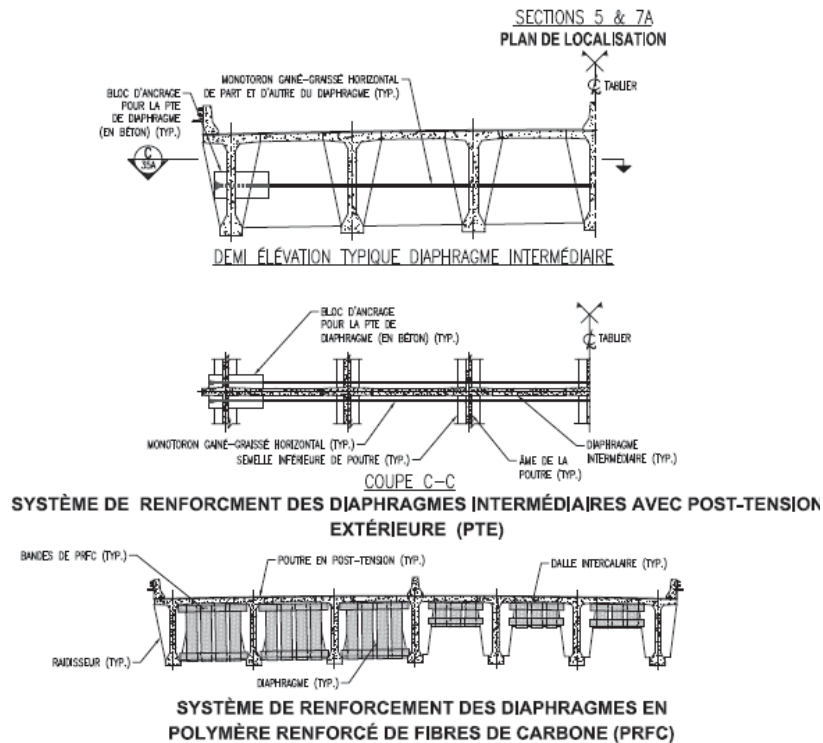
Poutres en béton – Renforcement des diaphragmes (source : plans nomenclature PJCCI)
